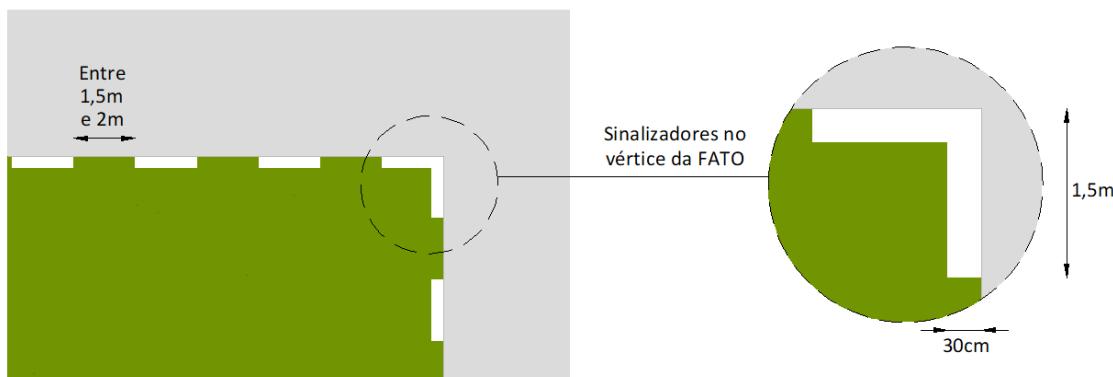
Sinalizadores de perímetro em FATO não pavimentada.
